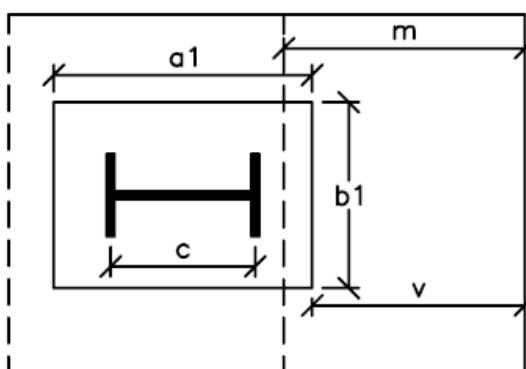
Vuelo de cálculo en una zapata con pilar metálico.
